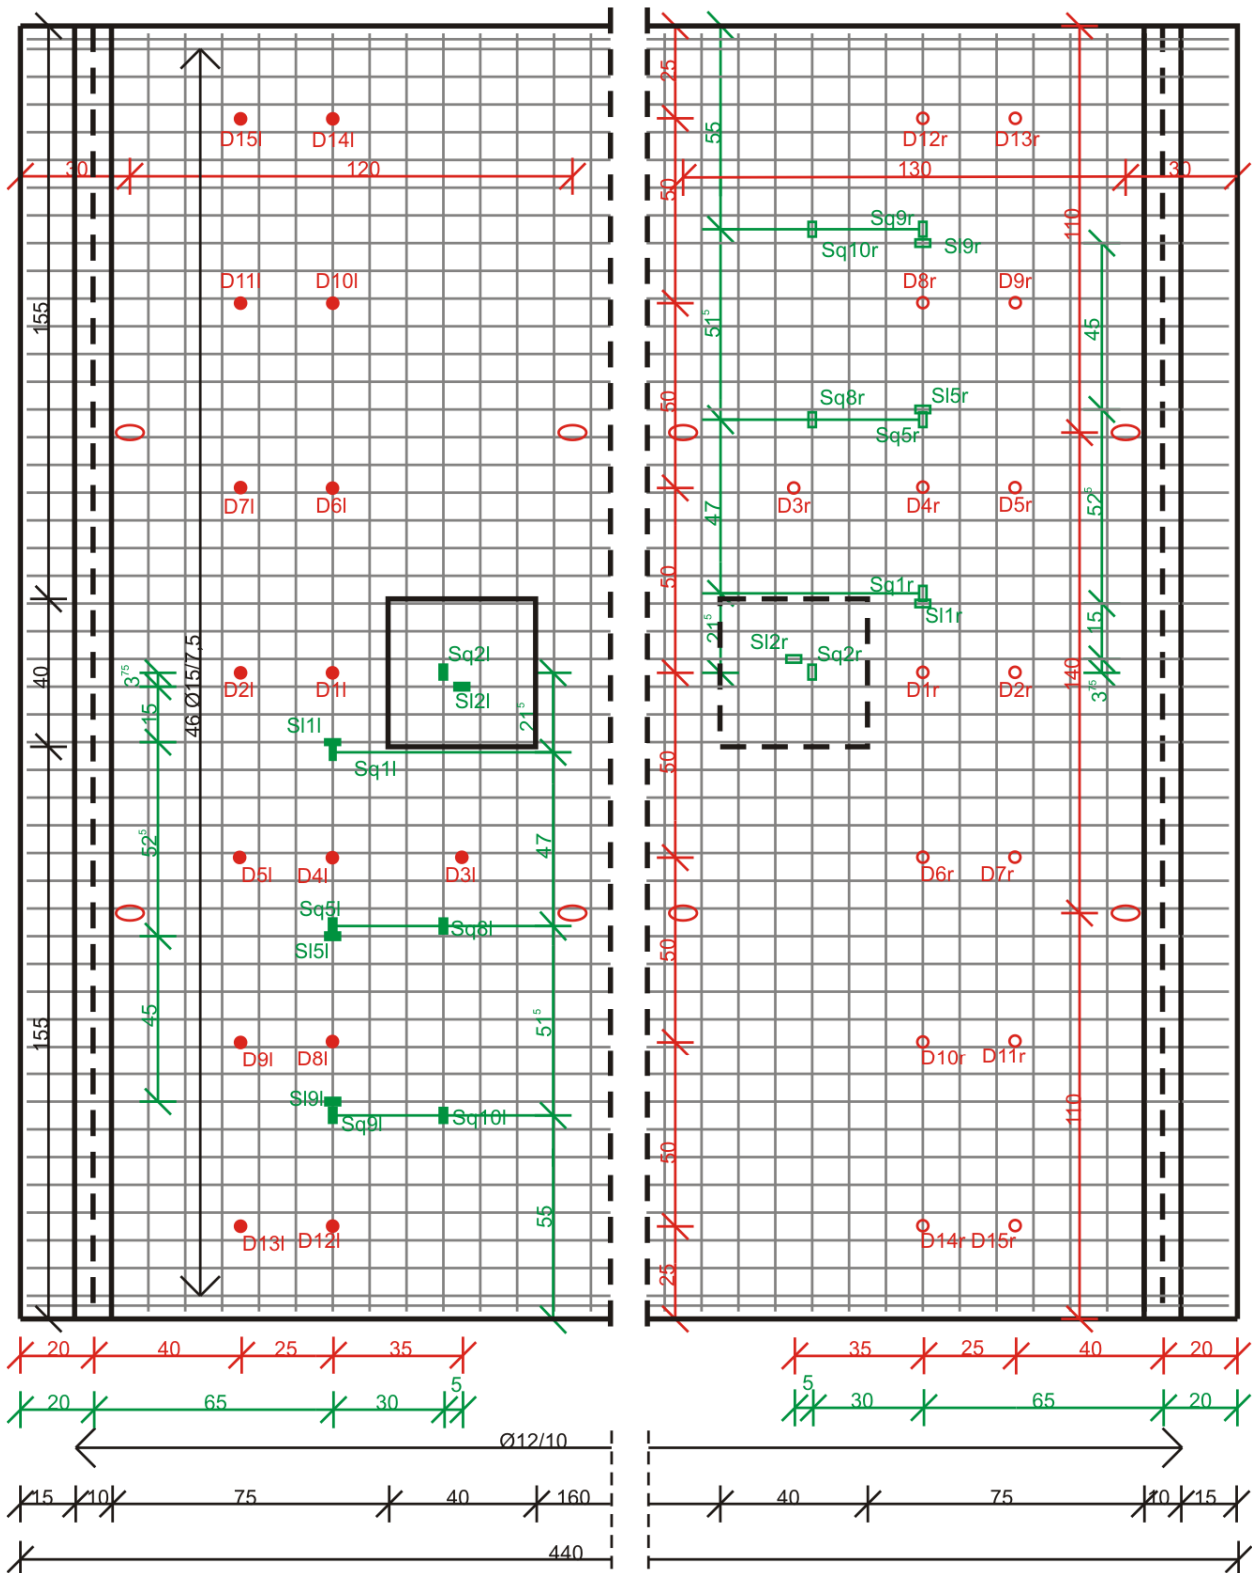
Messtechnikplan vor Betonage für den Versuchskörper S35B: Untere Bewehrungslage, Stahl-DMS, Dickenmessung und Lage der Transportanker
